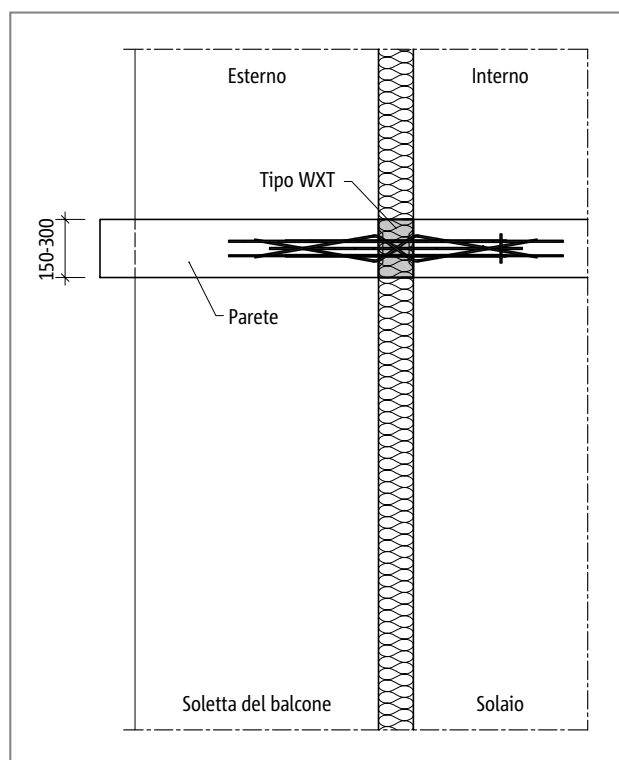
Schöck Isokorb® tipo WXT: pianta; balcone con lastre delle pareti portanti e termoisolate
